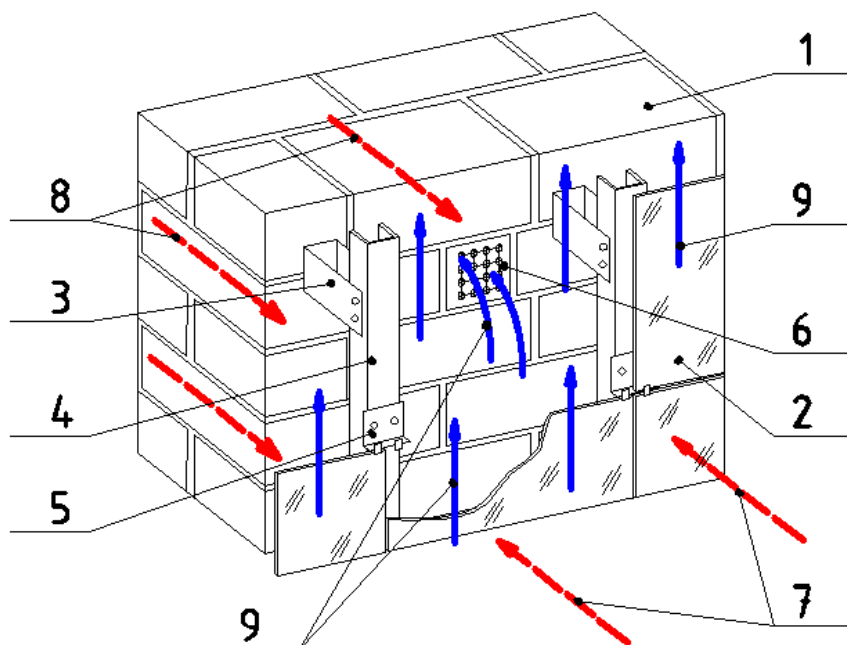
Схема конструкции фасада здания с рекуперативными приточными вентиляционными блоками, тепловых и воздушных потоков в конструкции: 1 – кирпичная кладка; 2 – светопрозрачный материал; 3 – несущий алюминиевый кронштейн; 4 – вертикальный профиль; 5 – кляммер; 6 – вентиляционное приточное устройство; 7 – тепловой поток солнечной радиации; 8 – трансмиссионный тепловой поток из помещения; 9 – воздушный поток наружного приточного воздуха.
